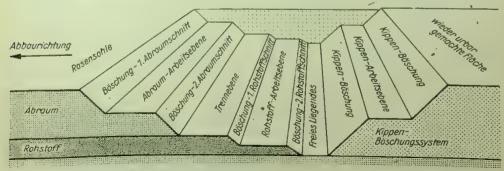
Flächen- und Raumelemente im Tagebau
